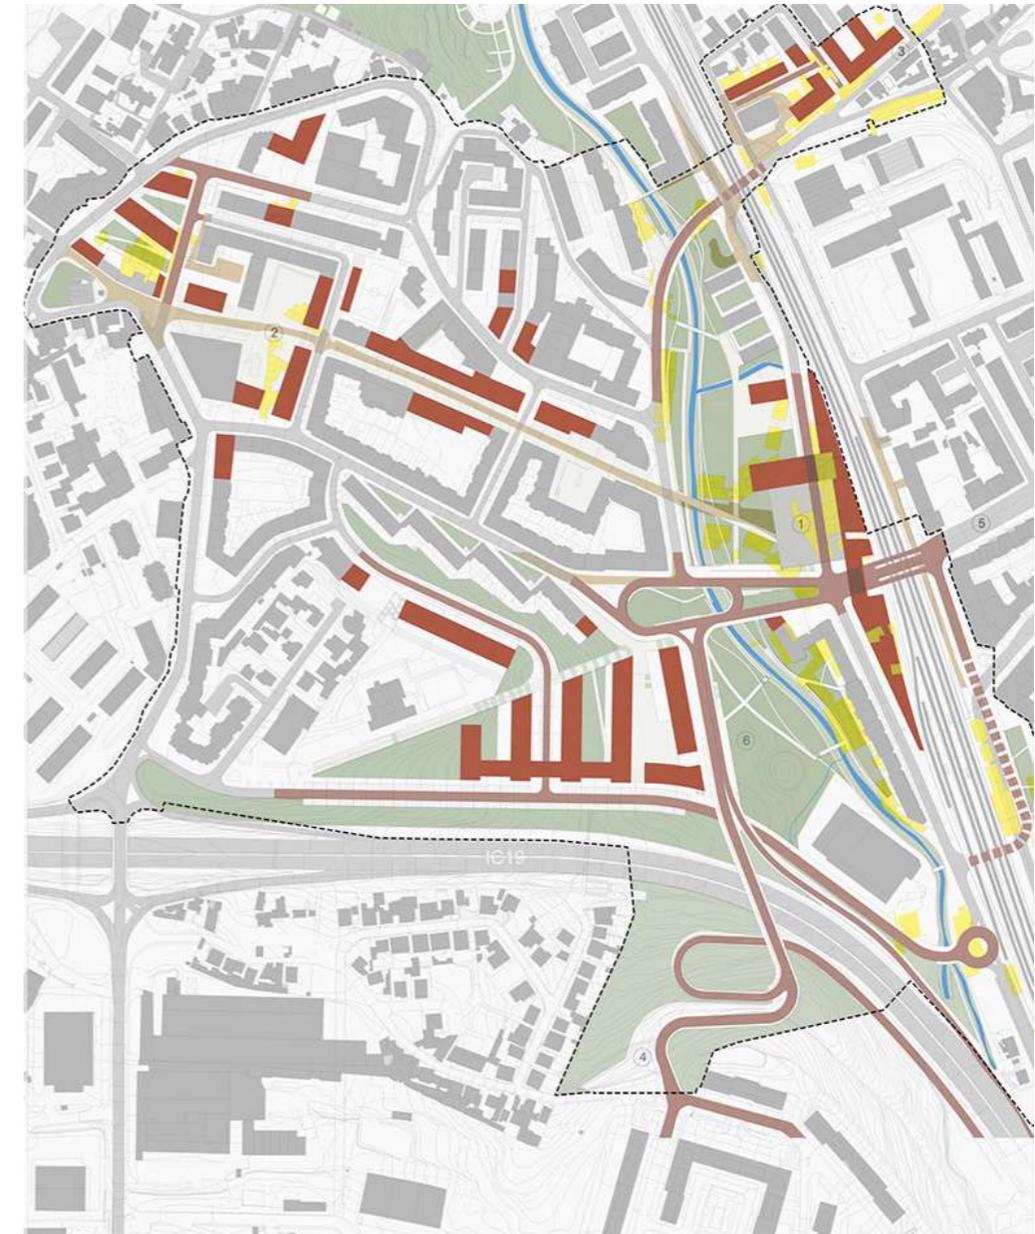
Planta Síntese do Plano de Pormenor da Área Central do Cacém (atelier RISCO)
